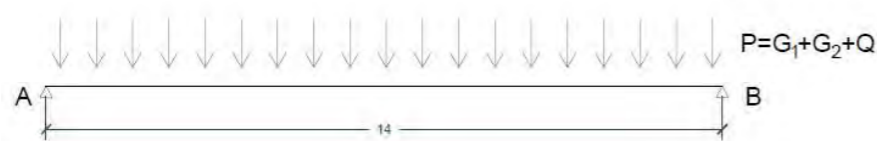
Schema statico della trave T8. Fonte: Autori.
